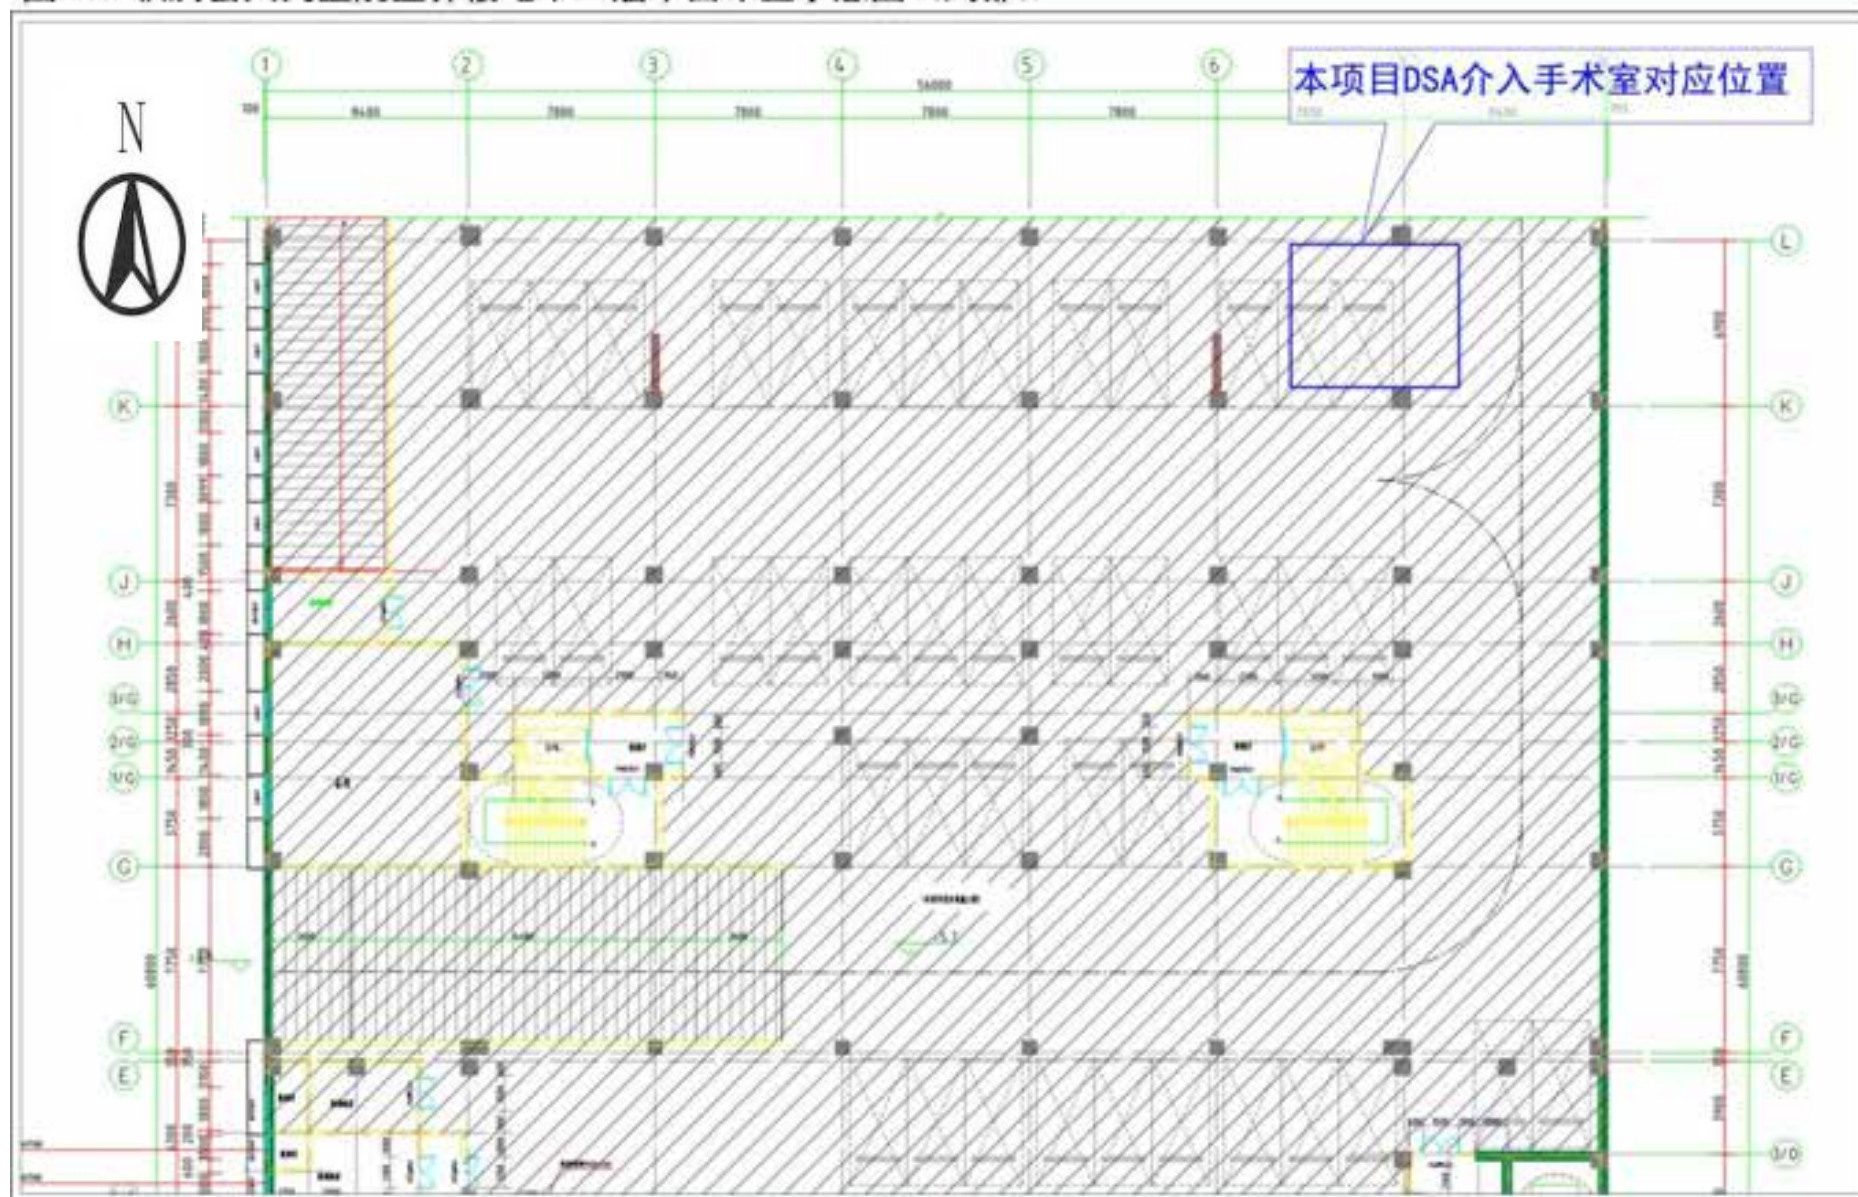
临朐县人民医院医养楼地下一层平面布置示意图（局部）
